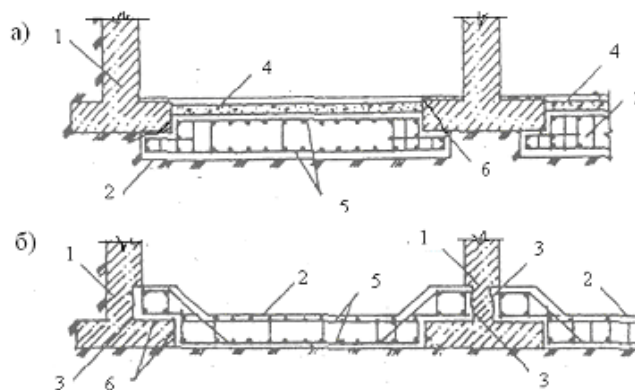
Варианты переустройства ленточного фундамента в плитный без пробивки сквозных отверстий в ленточных фундаментах:
